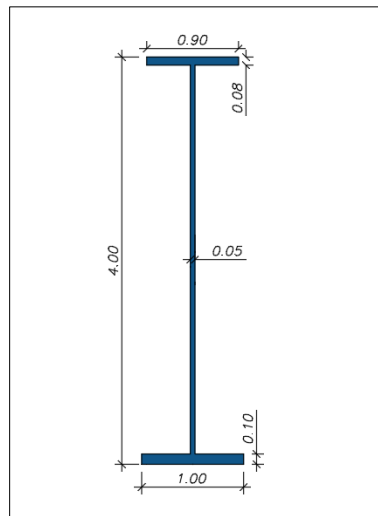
Les dimensions de la poutre métallique de la variante 2
